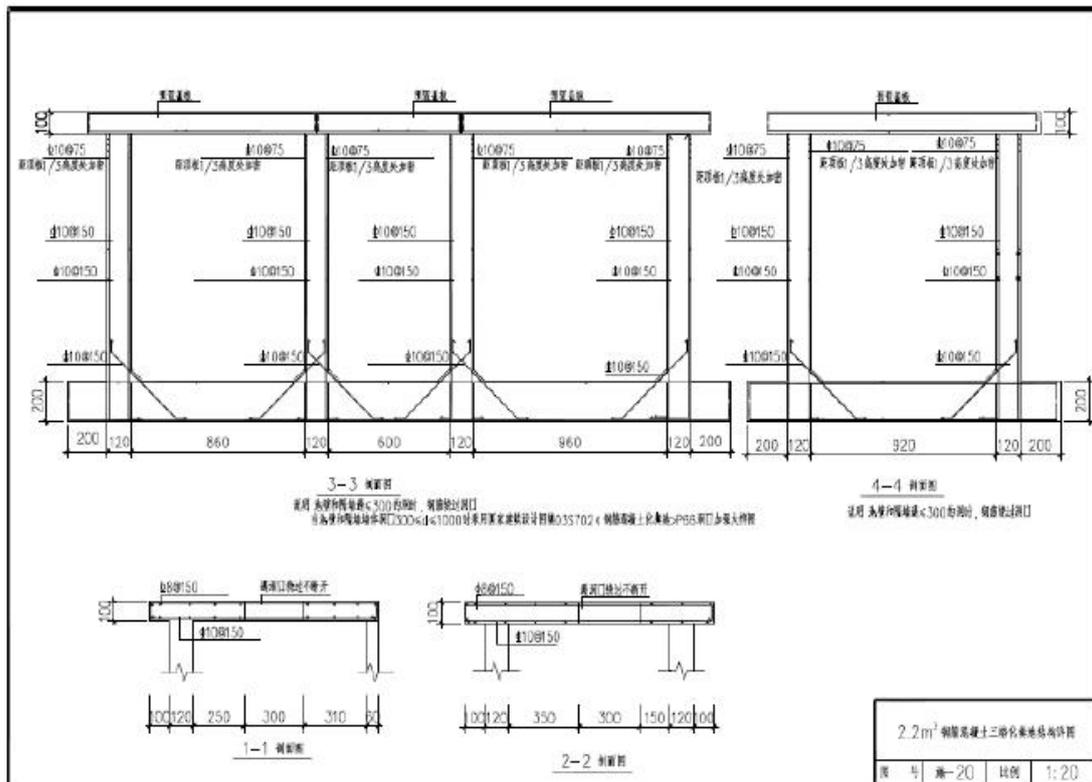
2.2 m<sup>3</sup> 钢筋混凝土三格式化粪池平面图
